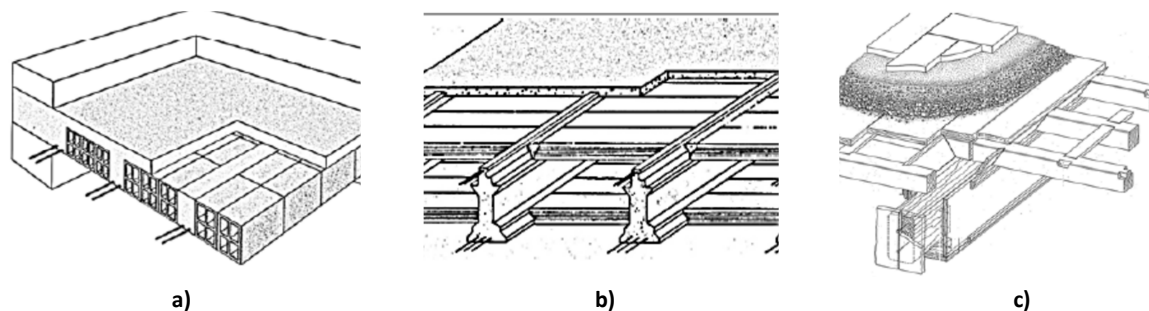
Rigidezza degli orizzontamenti: solai deformabili in laterocemento e travetti a) gettati in opera o b) prefabbricati e soletta non armata e c) solaio in legno a semplice o doppia orditura con tavolato
